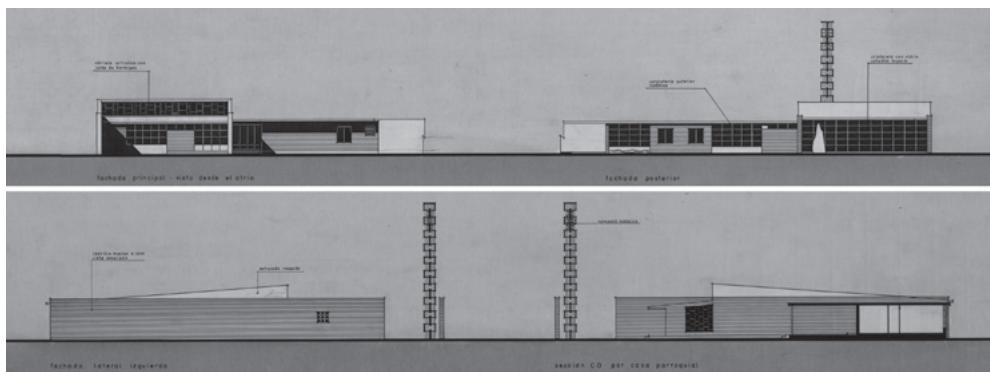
Planos de planta de la parroquia y sección por la nave, complejo residencial Vistahermosa (García Solera 1962)
